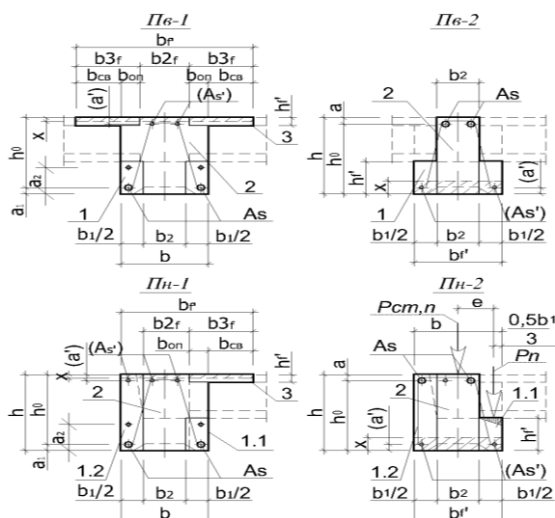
Расчетные модели сечения *АС СбМт* поясов: - внутренних стен в пролете (*Пв-1*) и над опорой (*Пв-2*); - наружных – в пролете (*Пн-1*) и над опорой (*Пн-2*); 1 и 1.1 – опорная ветвь сборной балки; 1.2 – тоже ограждающая; 2 – монолитный бетон; 3 – сжатая полка плиты перекрытия [рис. автора].
